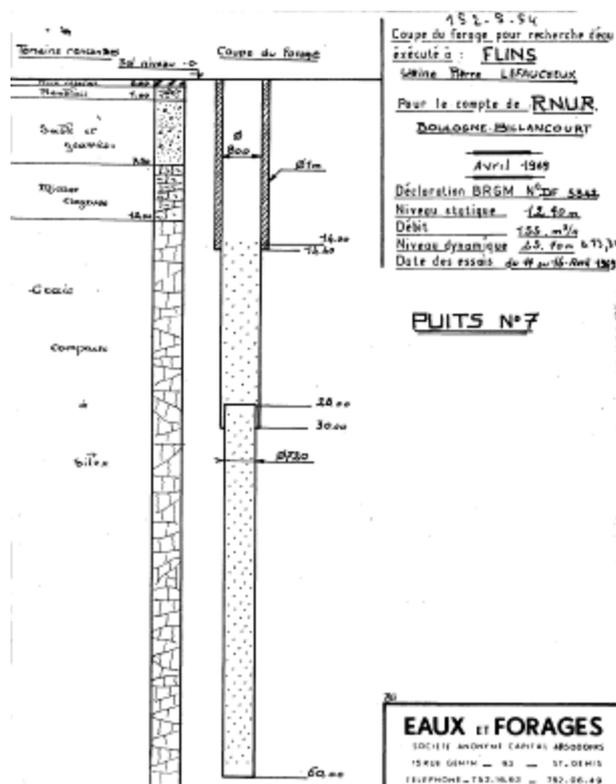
Coupe géologique du sondage situé à proximité du site (Source : Infoterre)
